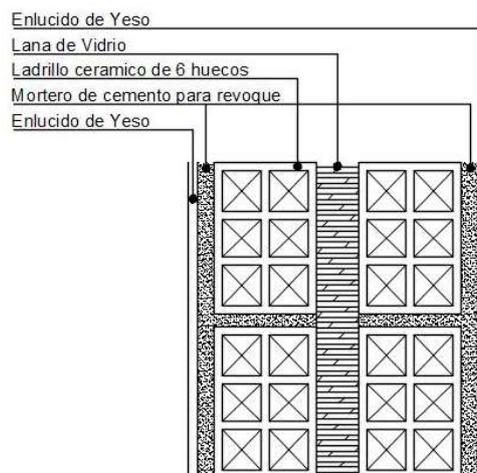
Detalle de partición interior de muro doble con aislamiento.
